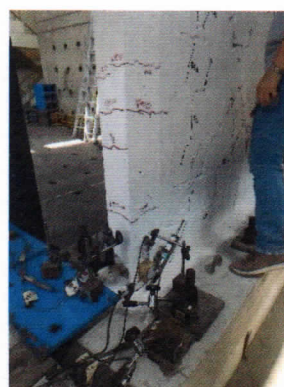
Formación de grietas diagonales en la parte inferior Este de la cara Norte para una distorsión de 1/400.
